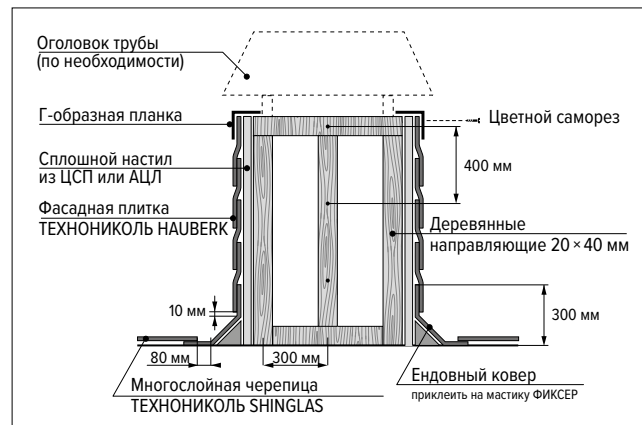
Монтаж фасадной плитки на вентиляционную трубу
